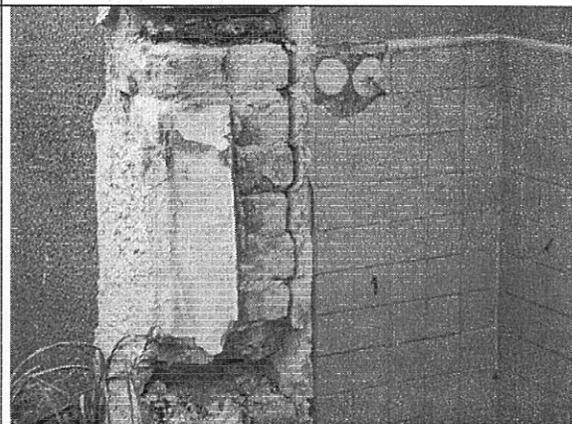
Grietas y pérdida de unidades de mampostería
